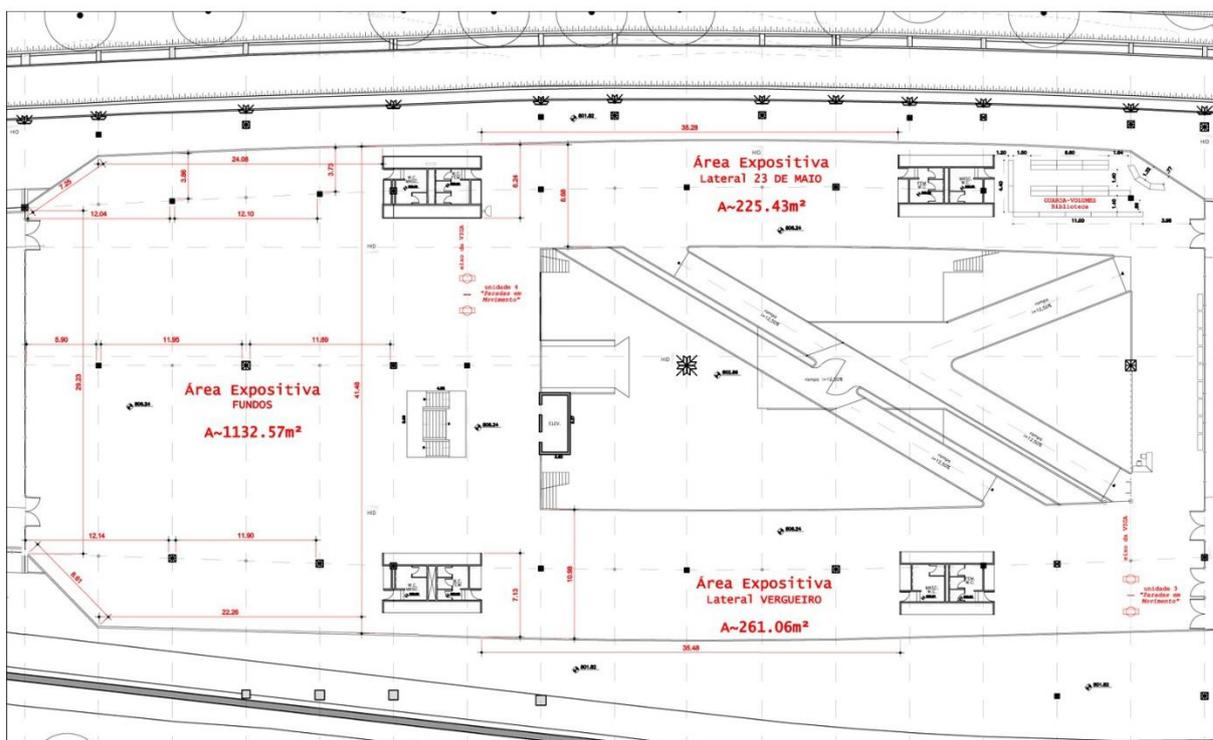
9 Planta Baixa do Pavimento Flávio de Carvalho / Cota 806
